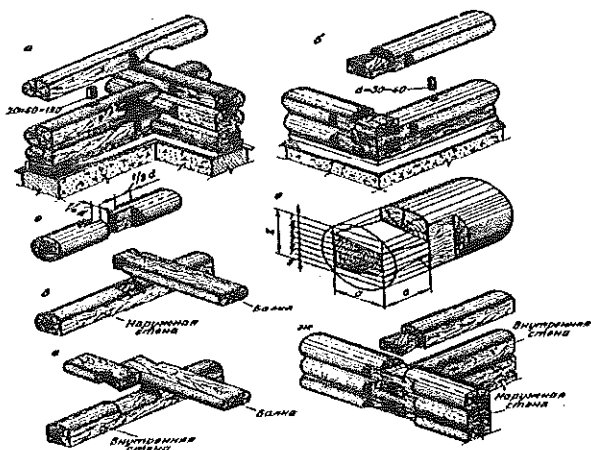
Узлы сопряжения деревянных бревенчатых стен
